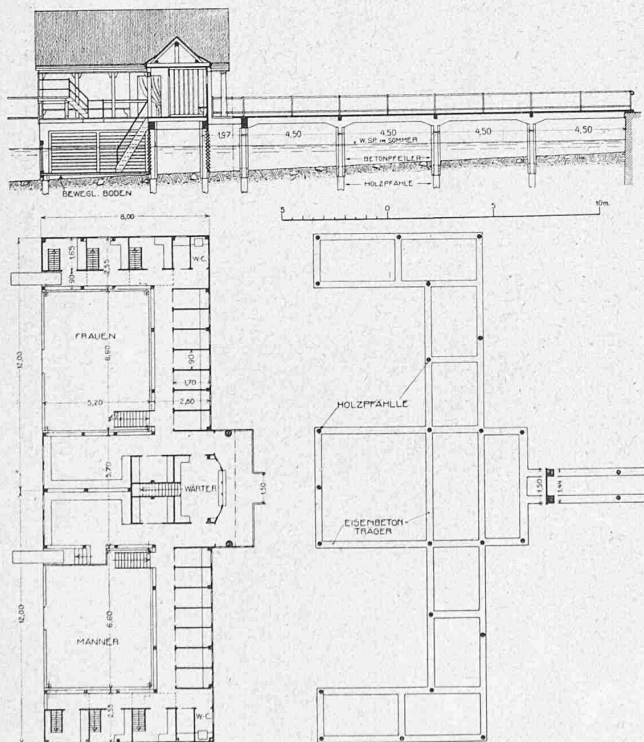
bis 3. Schnitt und Grundrisse zur Badanstalt Oberrieden. — 1: 300.
